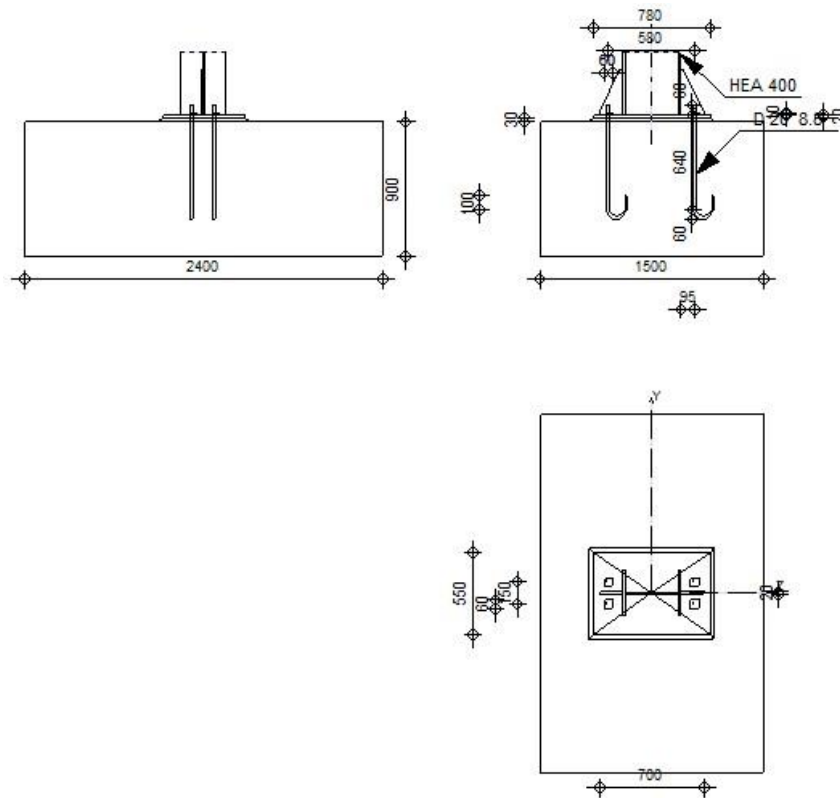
Détail de l'assemblage au niveau de pied de poteau
